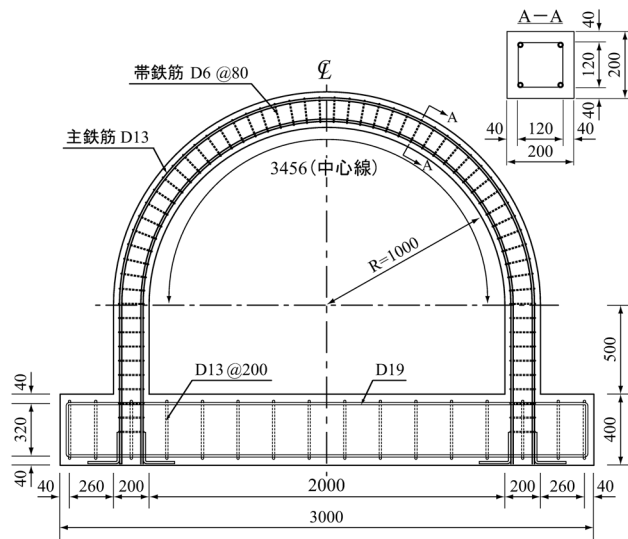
アーチ試験体の形状寸法（帯鉄筋有り）
